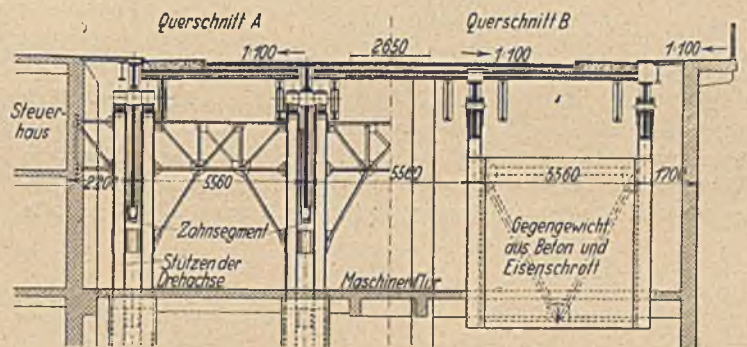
b. Klappbrücke, Querschnitt am Pfeiler.
